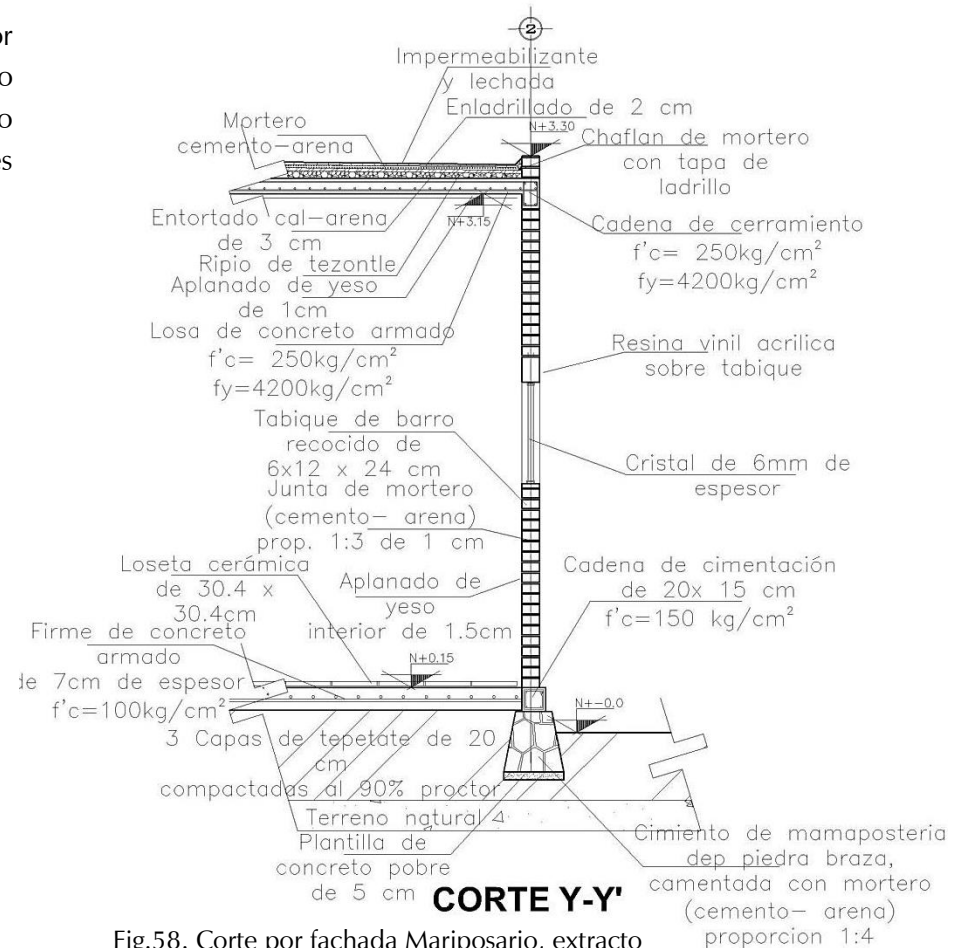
Corte por fachada Mariposario, extracto plano ES-5.
